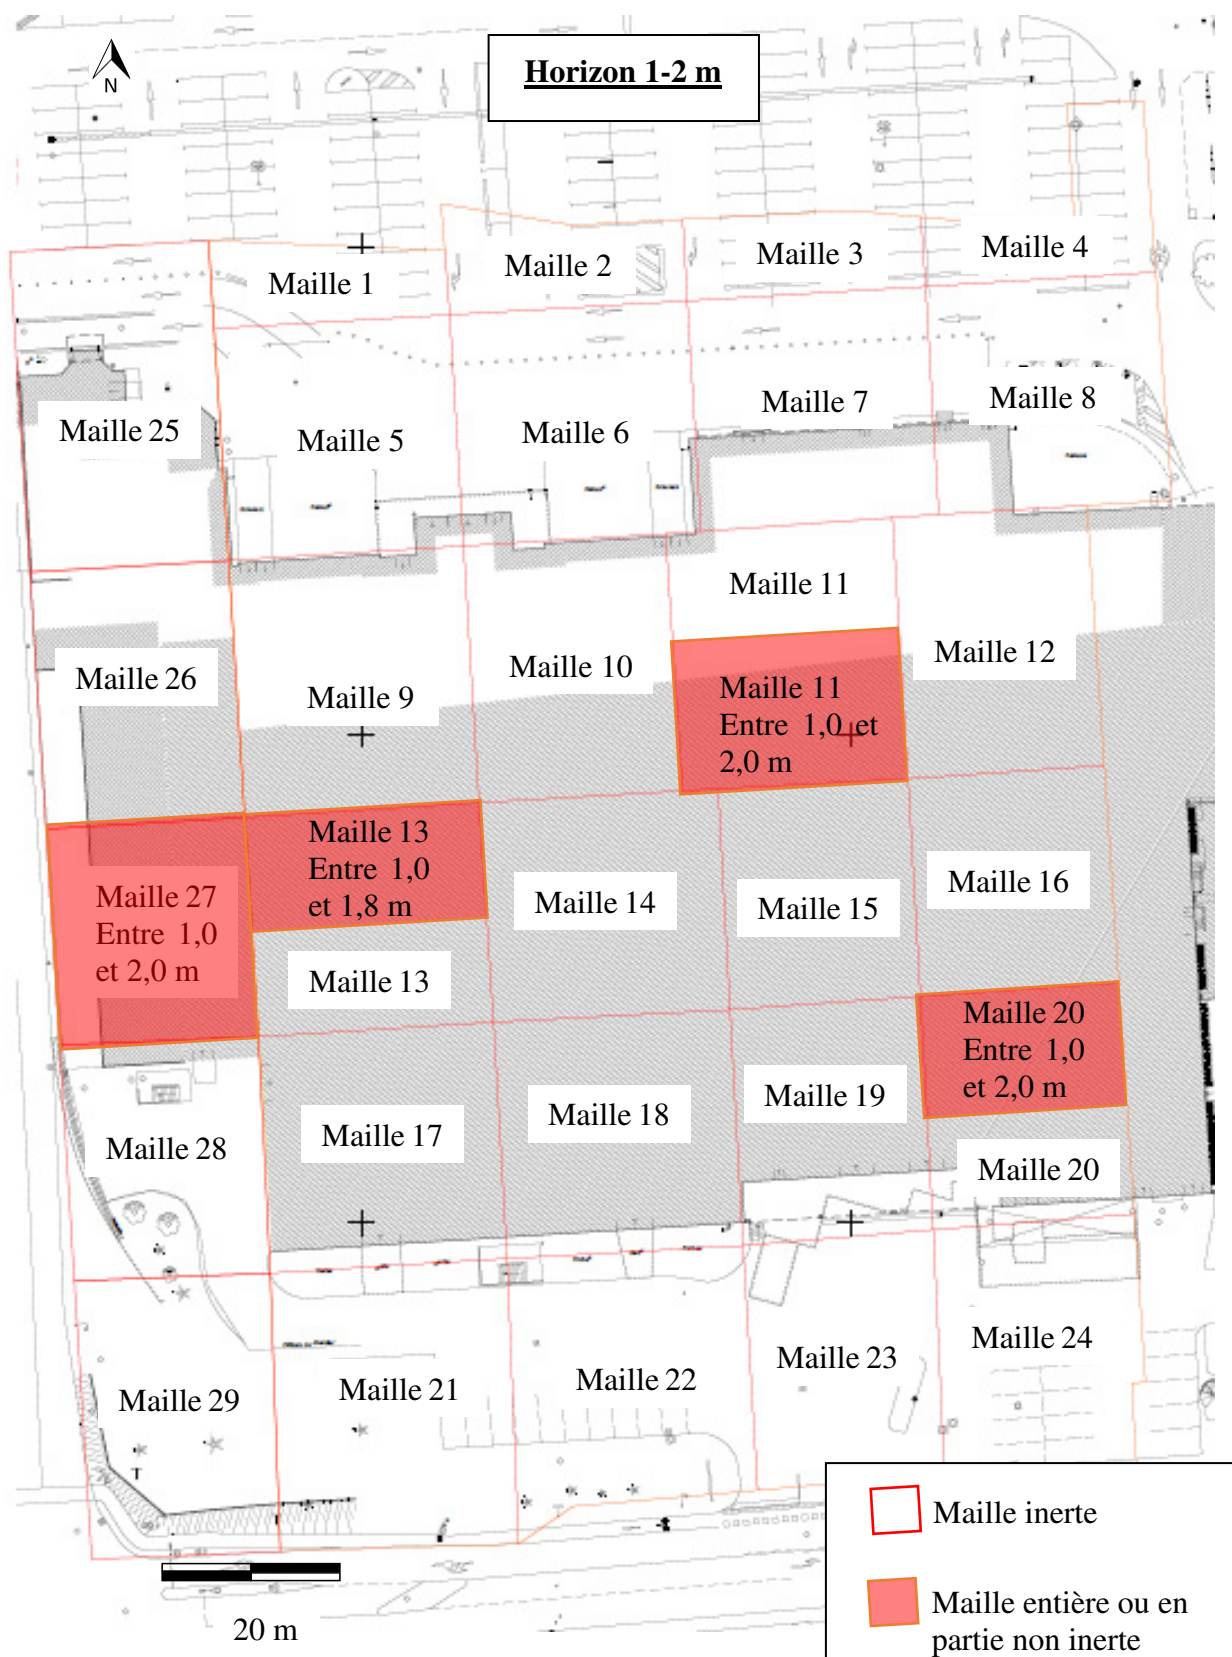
Plan de maillage présentant le caractère inerté des terres sur l'horizon 1 à 2 m de profondeur
